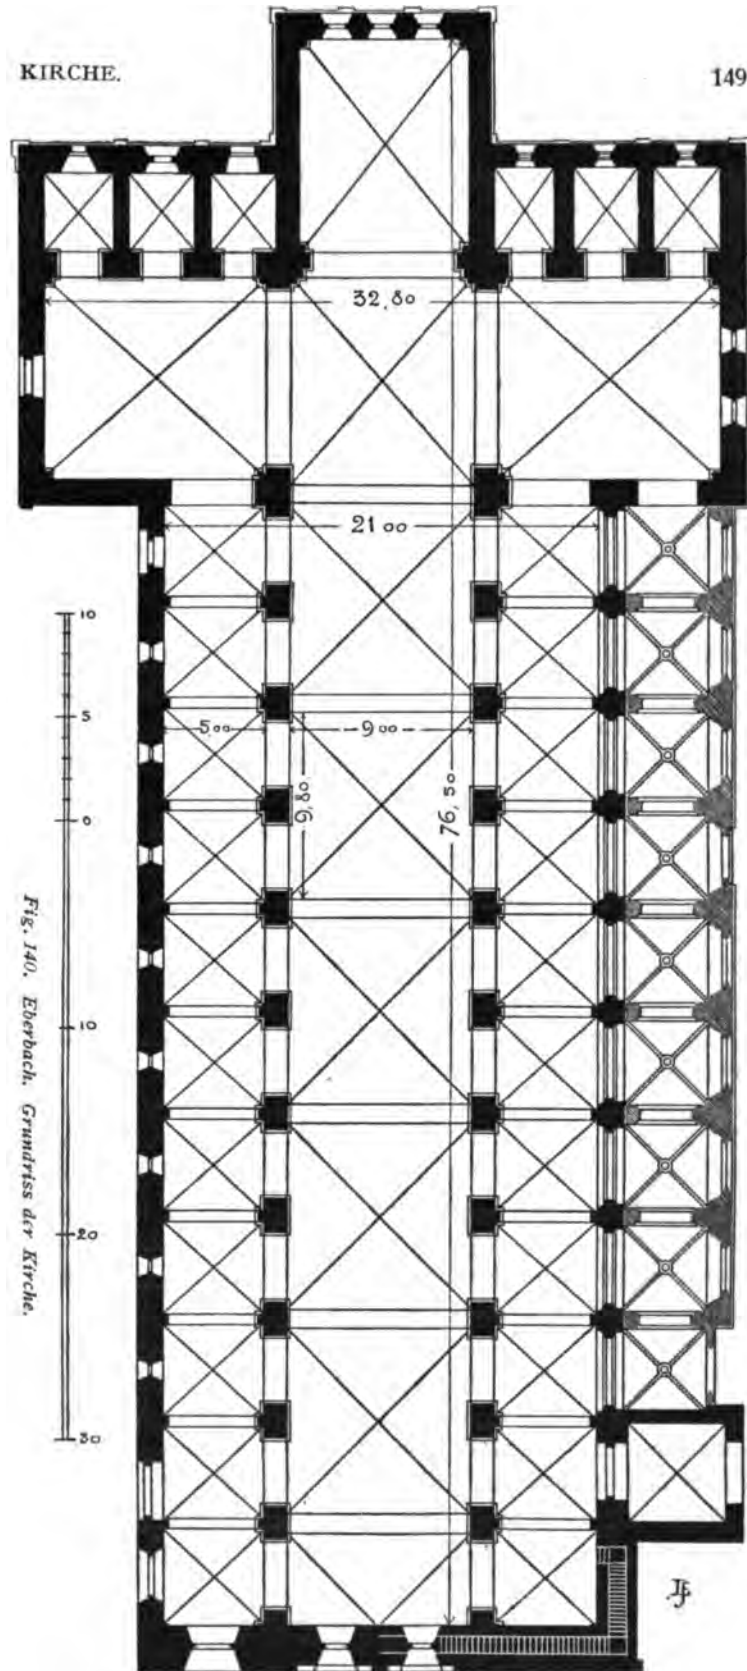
Eberbach. Grundriss der Kirche.
